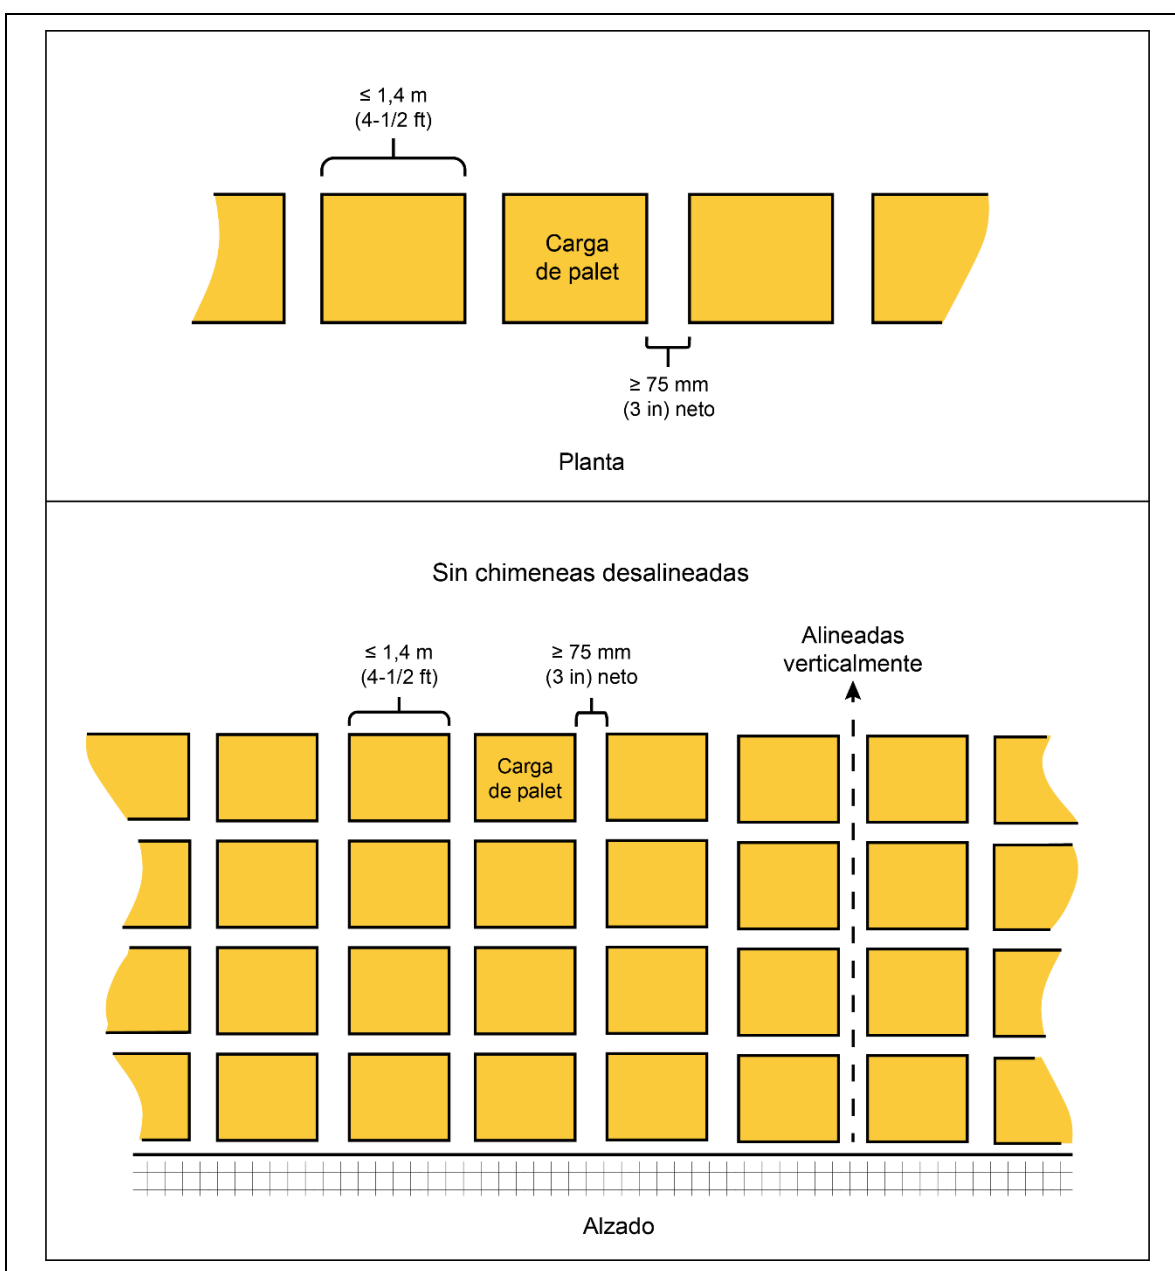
Configuración aceptable de las chimeneas transversales para estanterías simples, Opción 1
